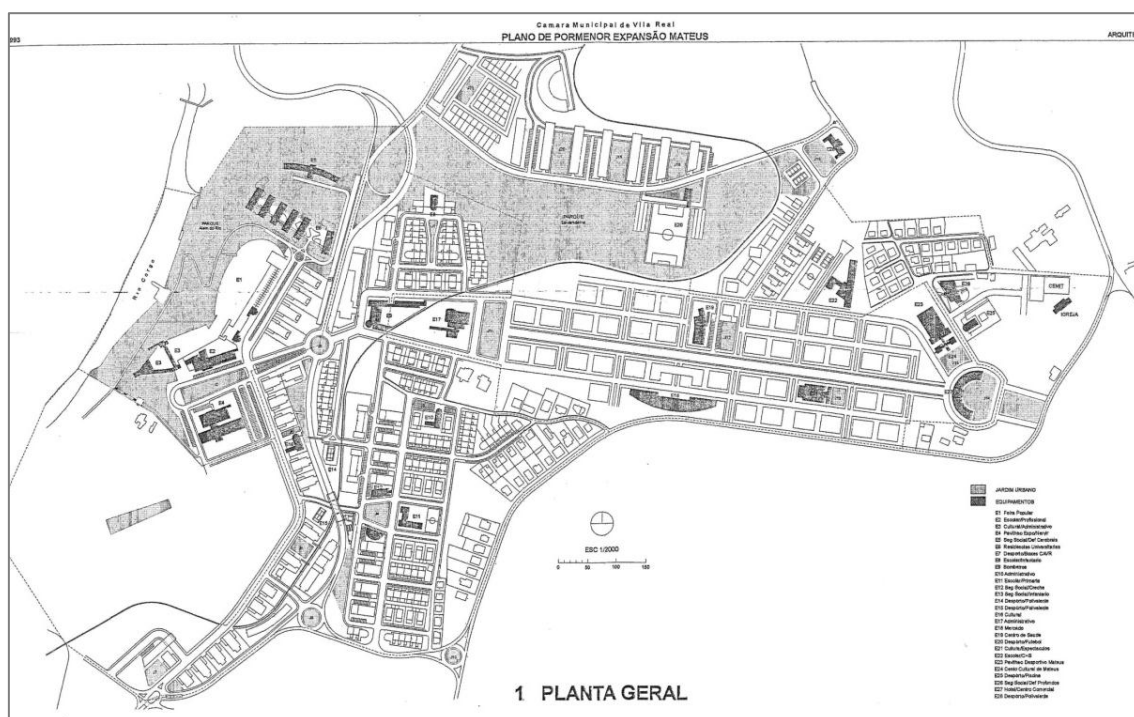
Planta Geral da Proposta de Plano do PPEM (1993)
